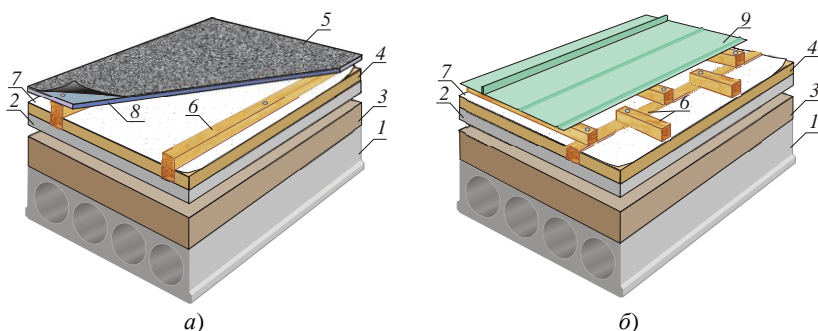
Рекомендуемые варианты дополнительного утепления вентилируемого покрытия с устройством рулонной (а) и стальной (б) кровли: 1, 2 – соответственно нижний и верхний ярусы несущего настила; 3 – старая теплоизоляция; 4 – дополнительная теплоизоляция; 5 – рулонная кровля; 6 – элементы обрешетки; 7 – ветрозащитная паропроницаемая пленка; 8 – дополнительный настил; 9 – стальная кровля
